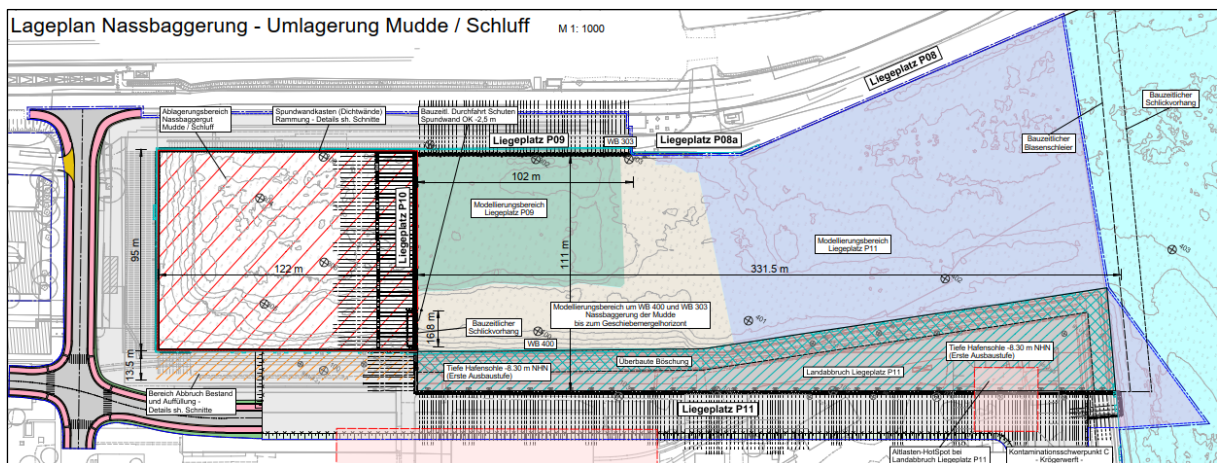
Lageplan Nassbaggerung – Mudde/Schluff
